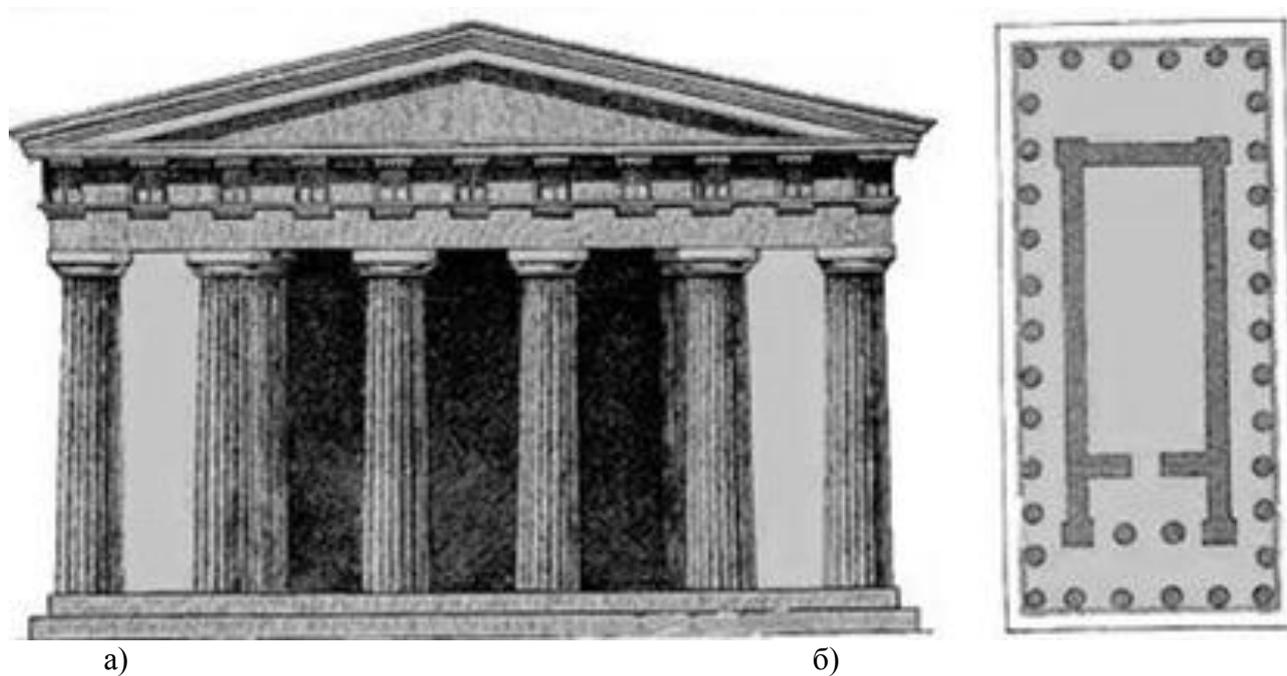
Древнегреческий храм (периптер); а – фасад; б - план.
